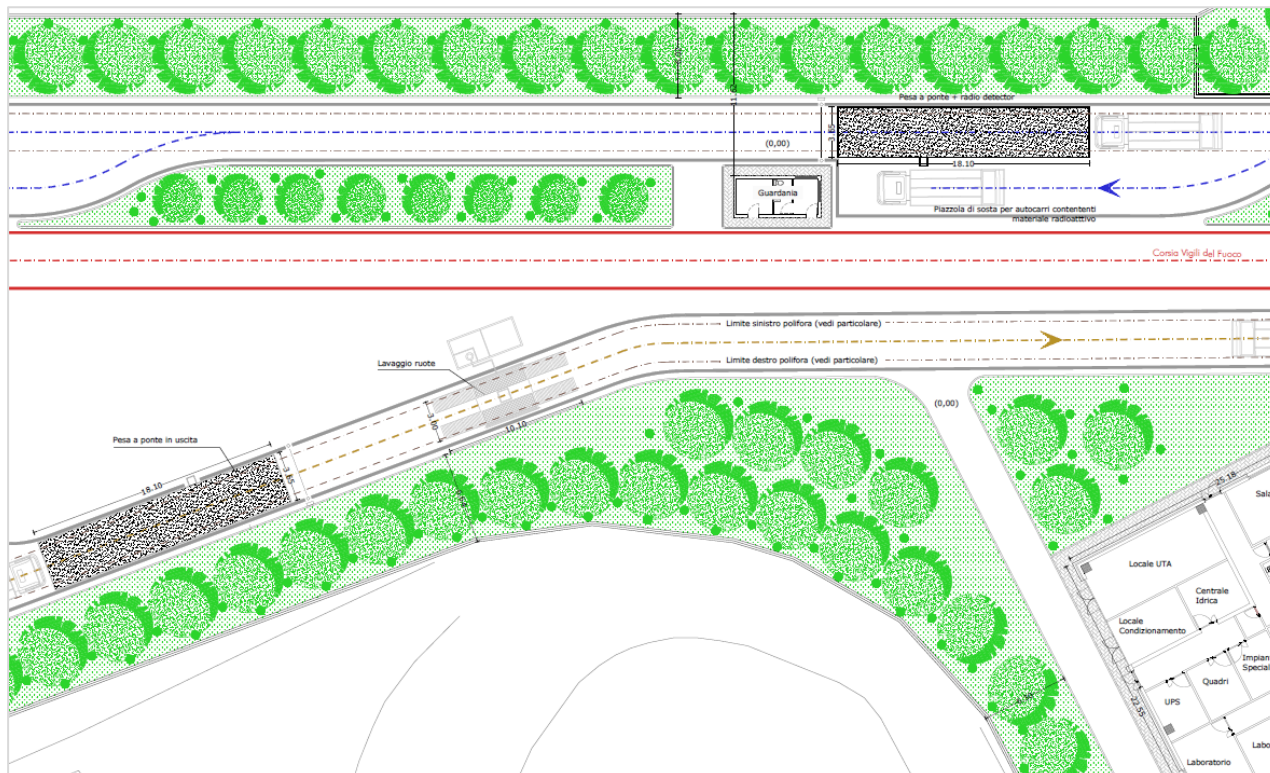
Posizionamento pesa in e out, lavaggio ruote, accettazione
